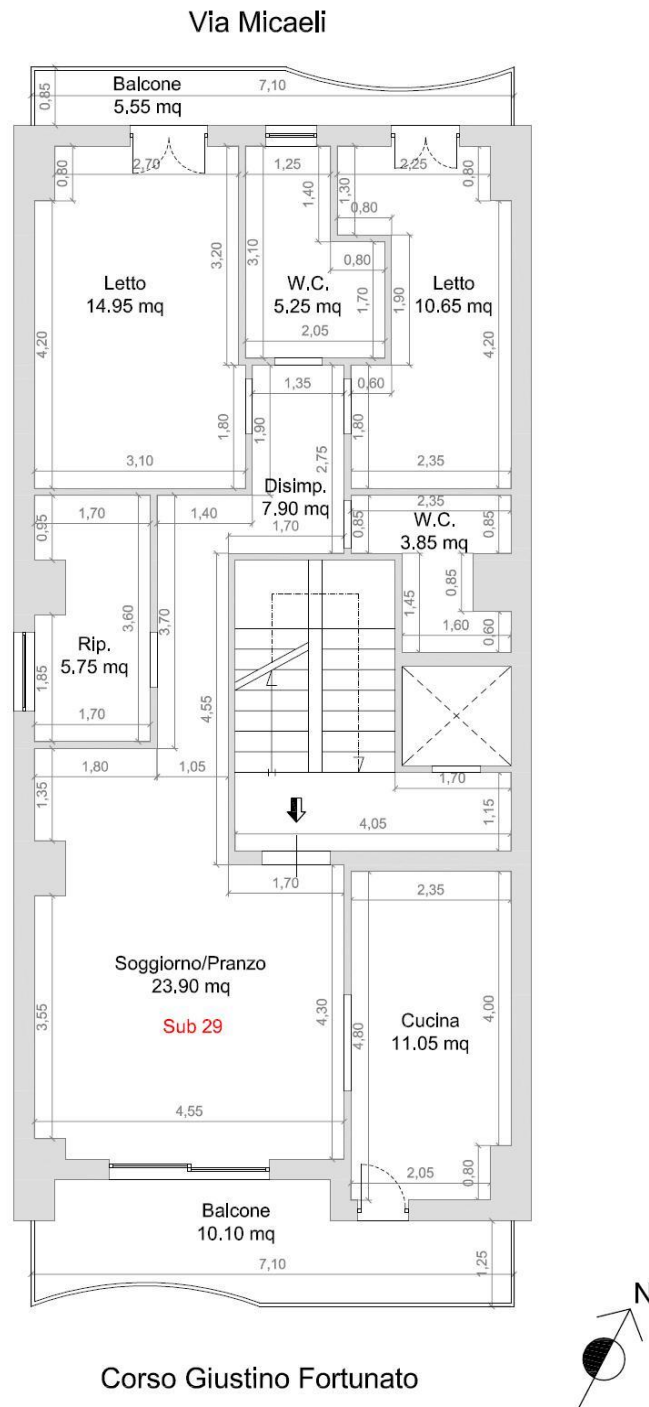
Planimetria Catastale Abitazione Piano Quarto
